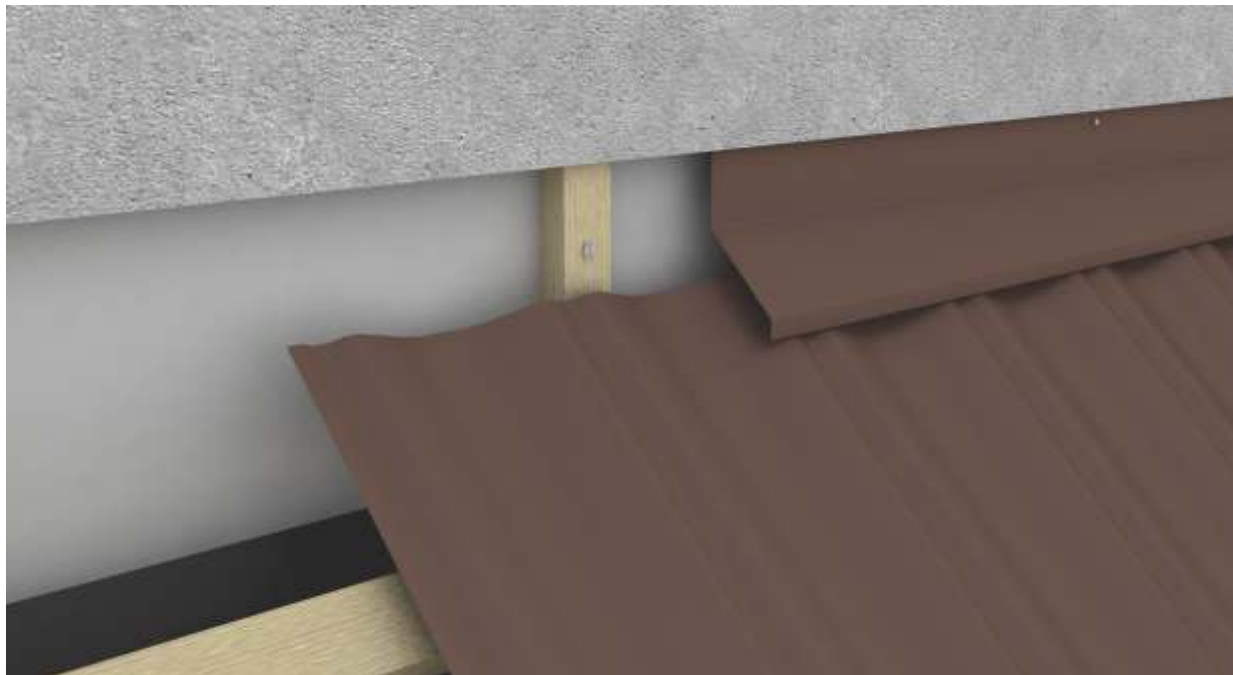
Montarea elementului de racord orizontal la perete. Varianta cu tablă nefălțuită.
